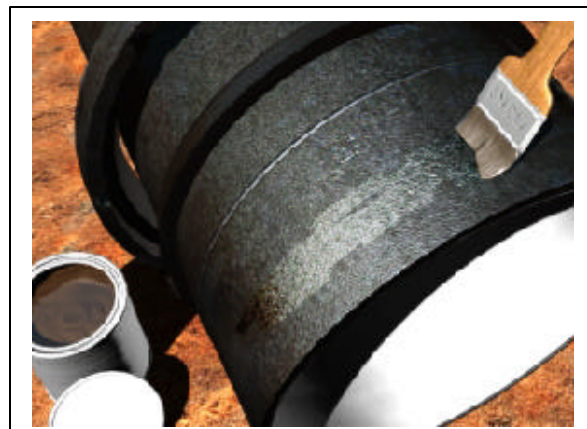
O lubrificante deverá ser aplicado com pincel.
